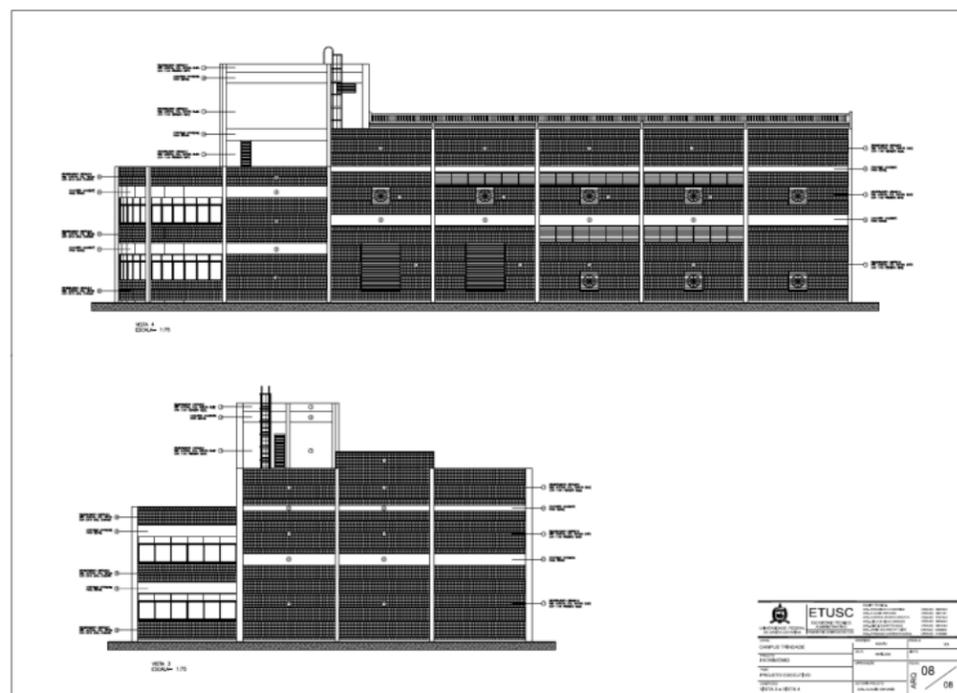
IMAGEM REFERENTE A FACHADA PRINCIPAL DO PROJETO IMPLANTADO EM OUTRAS IFES
